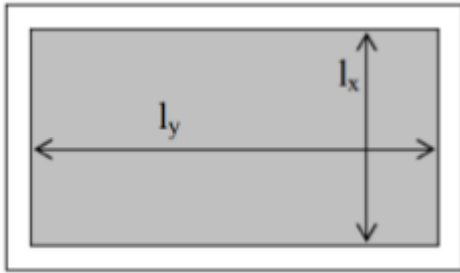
panneau d'un plancher dalle pleine [12].
